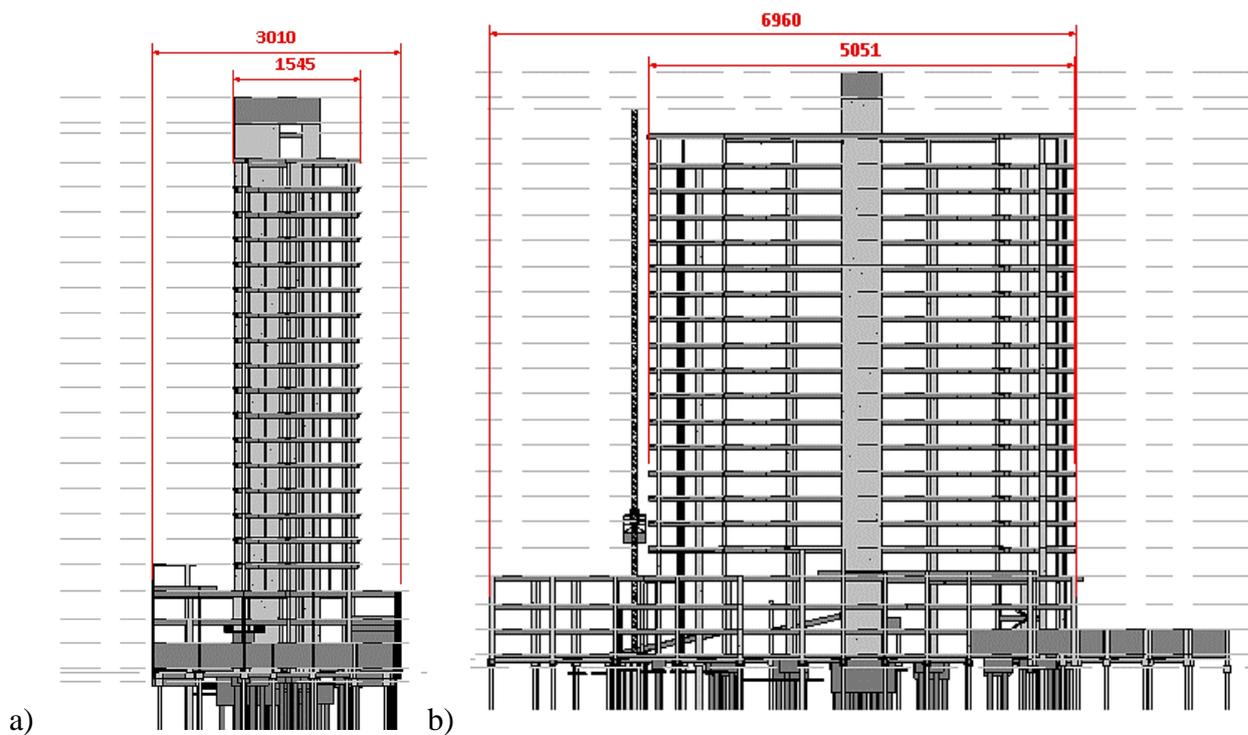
a) Elevação da fachada oeste da edificação e b) elevação da fachada norte.
